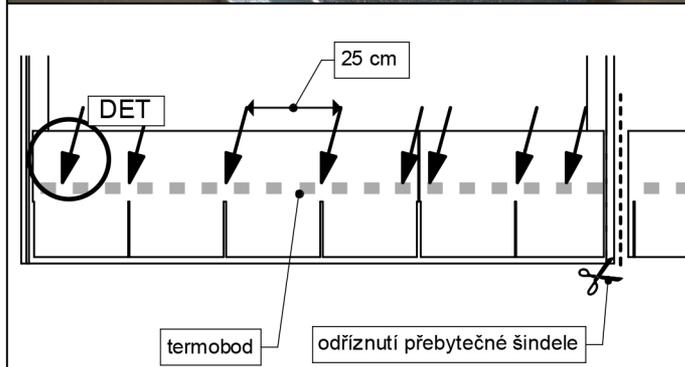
Půdorysný pohled na střechu (se shora), použití bitumenového tmelu
